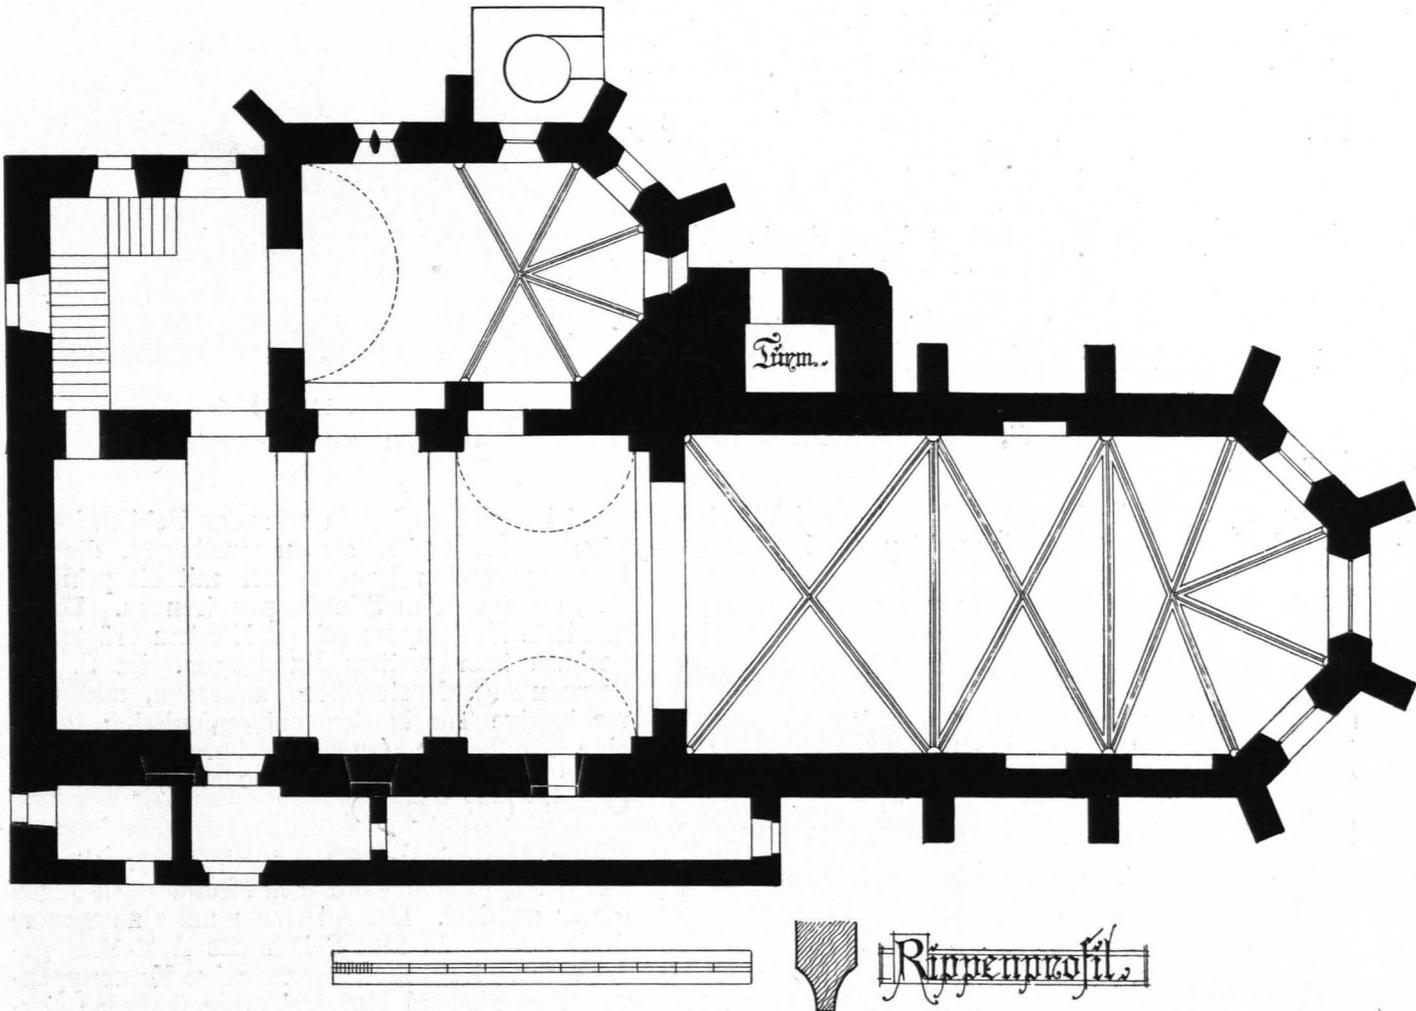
Horn, Pfarrkirche, Grundriß 1:200 (S. 364)
